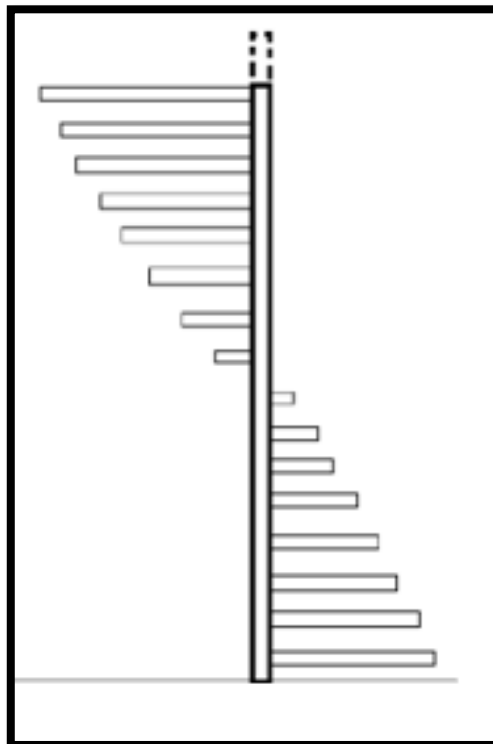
Escalera helicoidal con apoyo central. Morales (2010).
